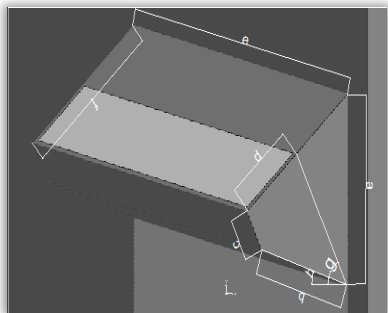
Dimensiones de guía de luz sombreada. [18]
